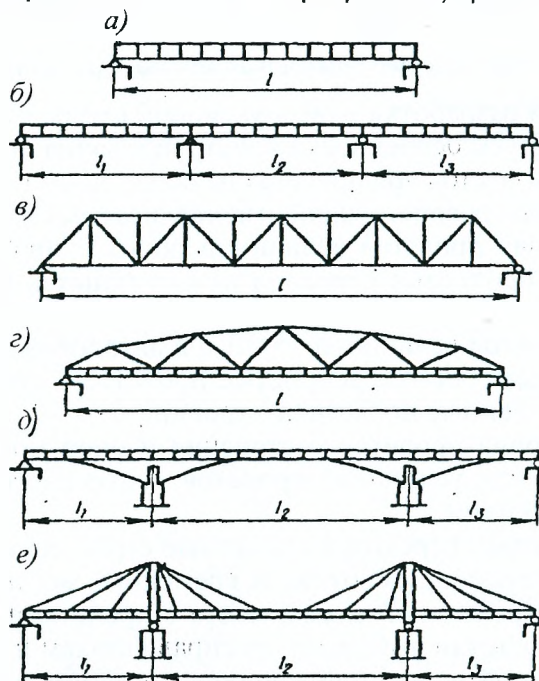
Металлические пролетные строения мостов: а – балочное разрезное со сплошной стенкой; б – балочное неразрезное со сплошной стенкой; в – балочное разрезное сквозное; г – комбинированное с гибким верхним поясом; д – комбинированное с арочными подпругами; е – вантовое
